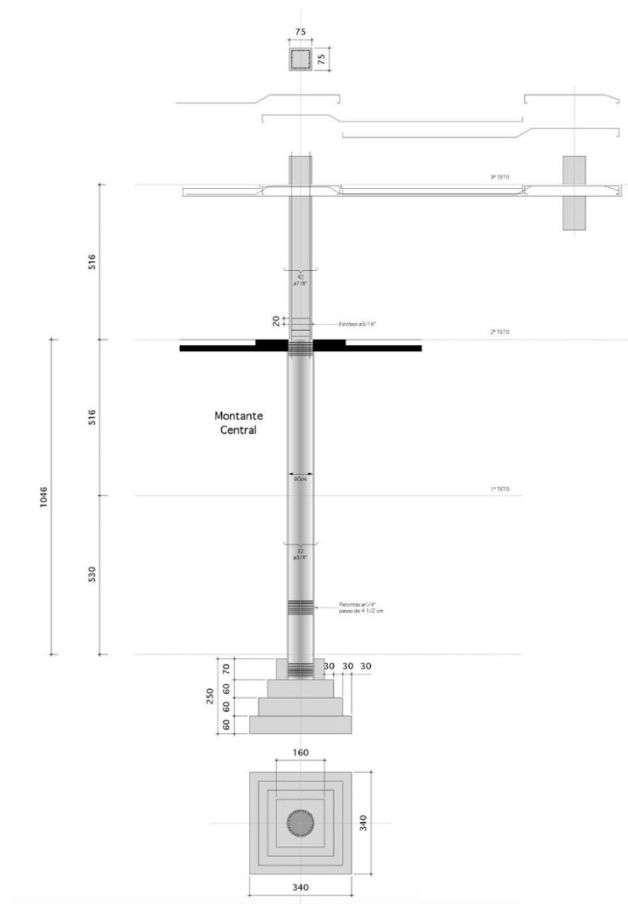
Esquema construtivo da execução de fundações, armaduras e seção de pilares e lajes do bloco administrativo. Fonte: IPHAN/Arquivo Noronha Santos: Documento n. M6G6/ANS0630 in VASCONCELLOS, p.142, 2004.
